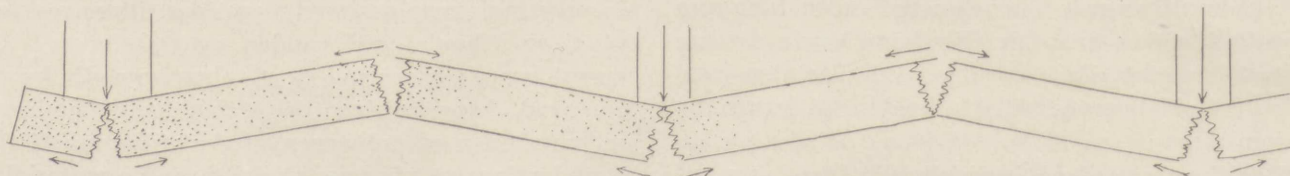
Betonfundament uten armering, hvor brud har fundet sted.
